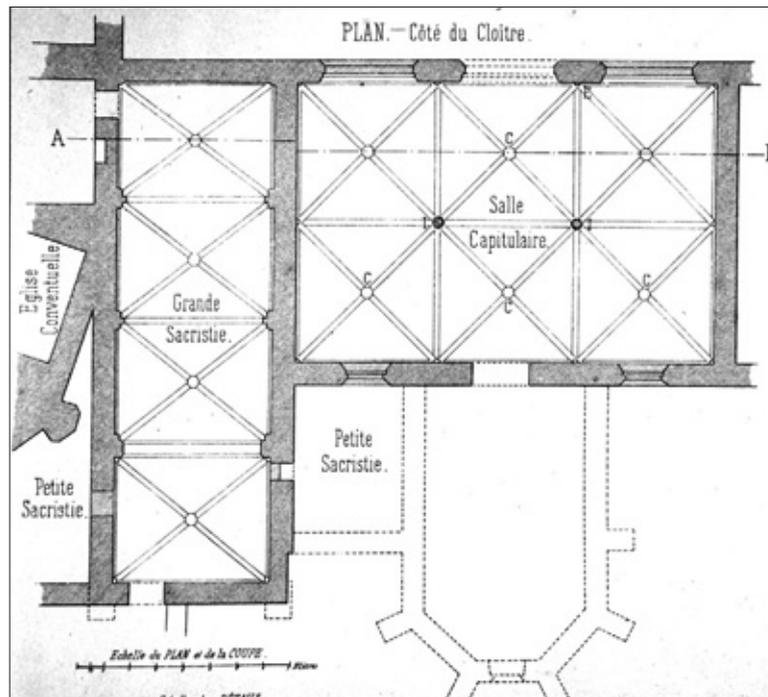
PLAN DE LA SACRISTIE et de la salle capitulaire, 1877, planche K, détail. *Plan de J.-J. Esquié.
